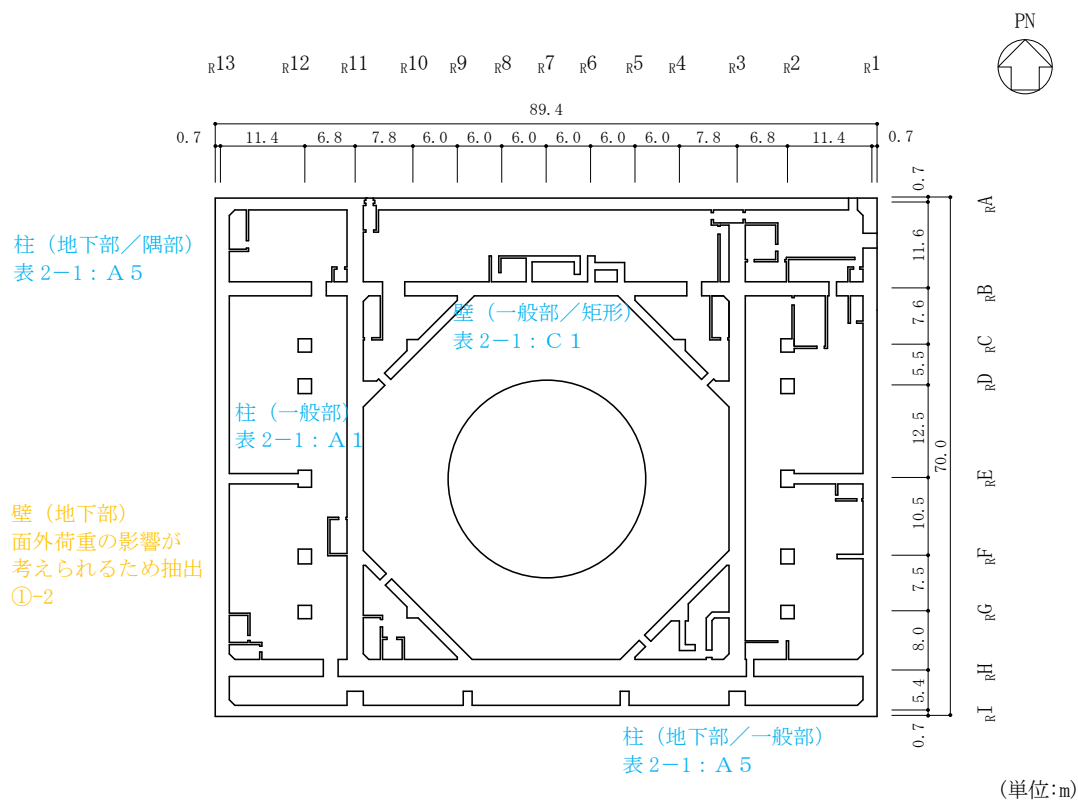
(2) 原子炉建物の概略平面図 (EL 8.8m)
